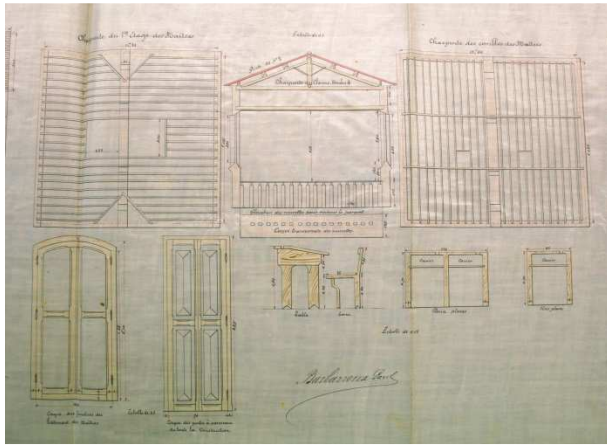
Projet de construction d'un groupe scolaire laïque, coupe, croisée et parquet des classes. Barbarroux Paul (architecte). Papier entoilé, dessin à l'encre et aquarelle, 300 x 31,5 cm, 11 février 1883. Archives Départementales du Var, 2 Op 64/2.
